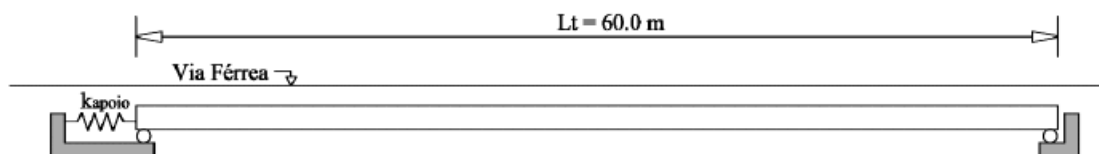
Esquema estrutural do caso E1-3 (Delgado, 2013).
